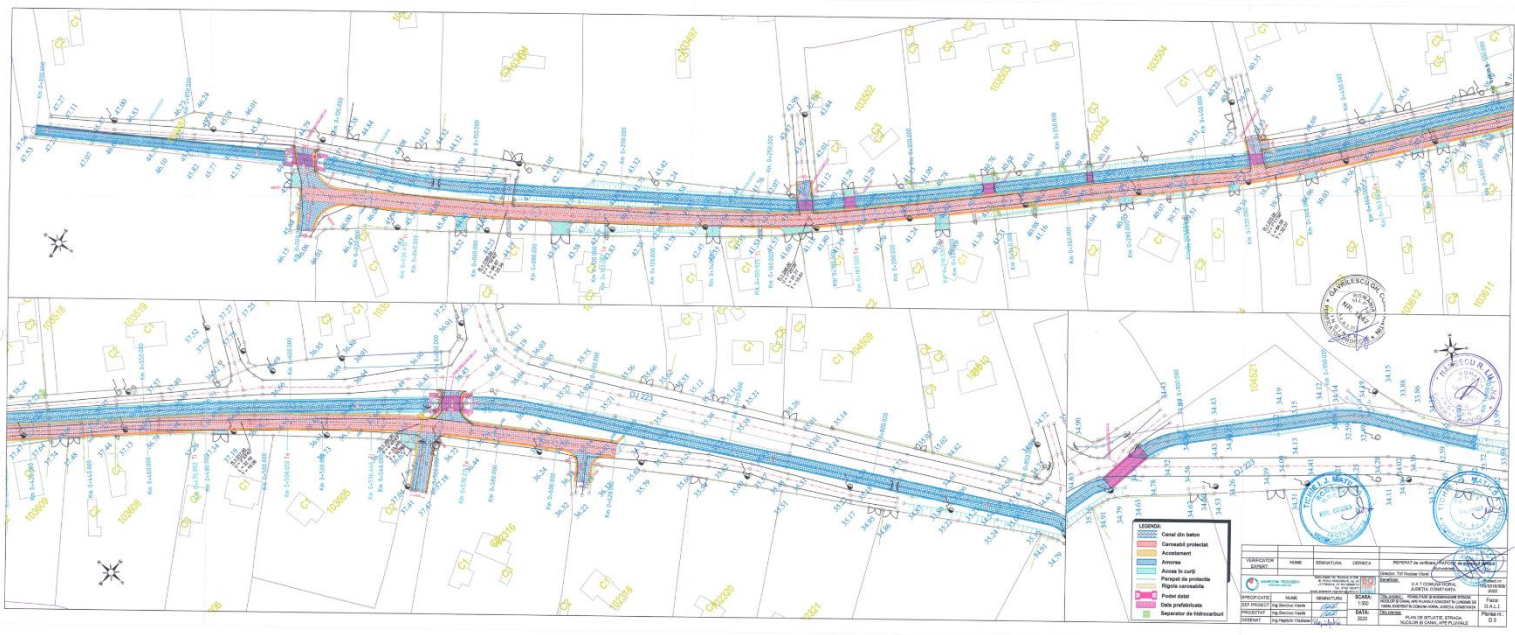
Plan de situație, strada Nucilor și canal ape pluviale
